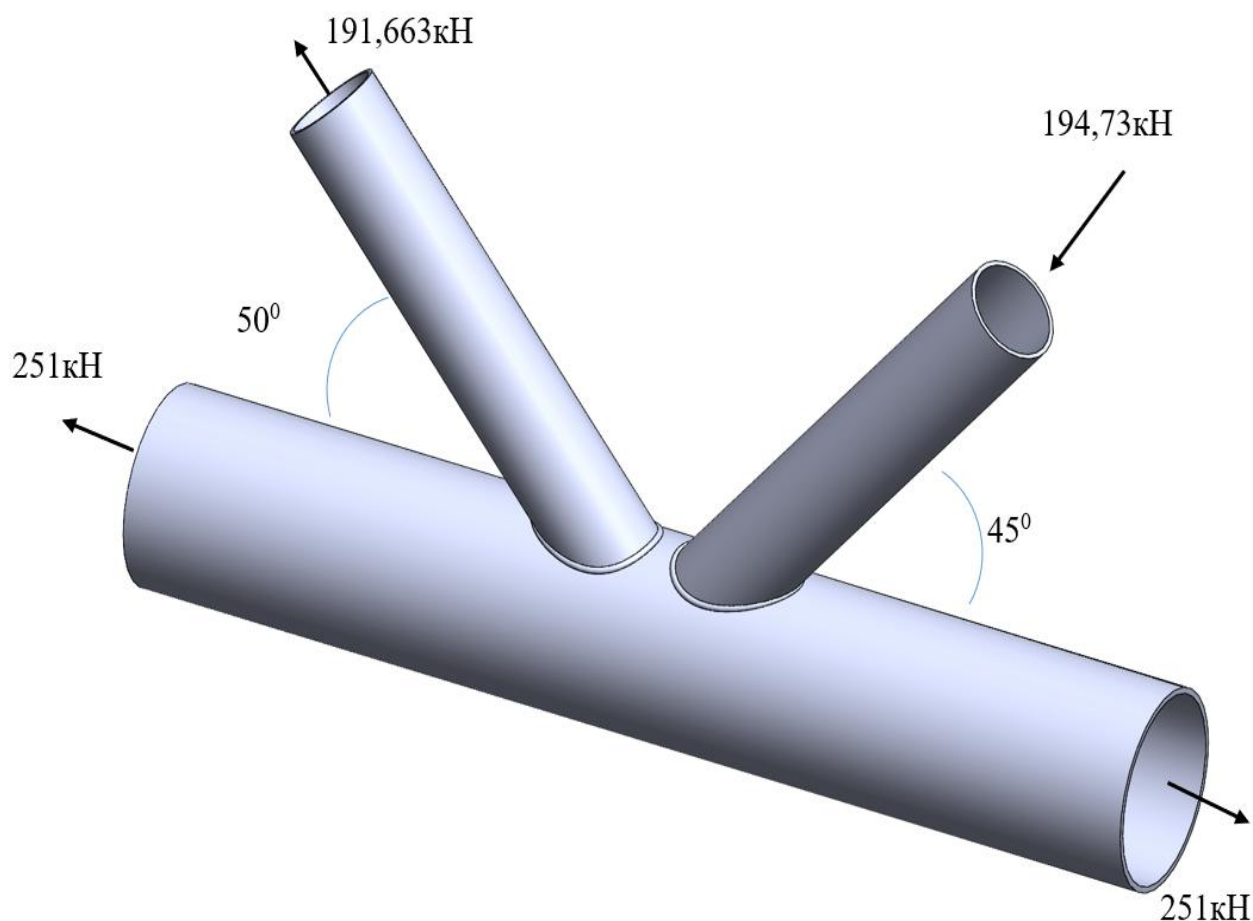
Загальний вигляд зварного вузла нижнього пояса ферми
